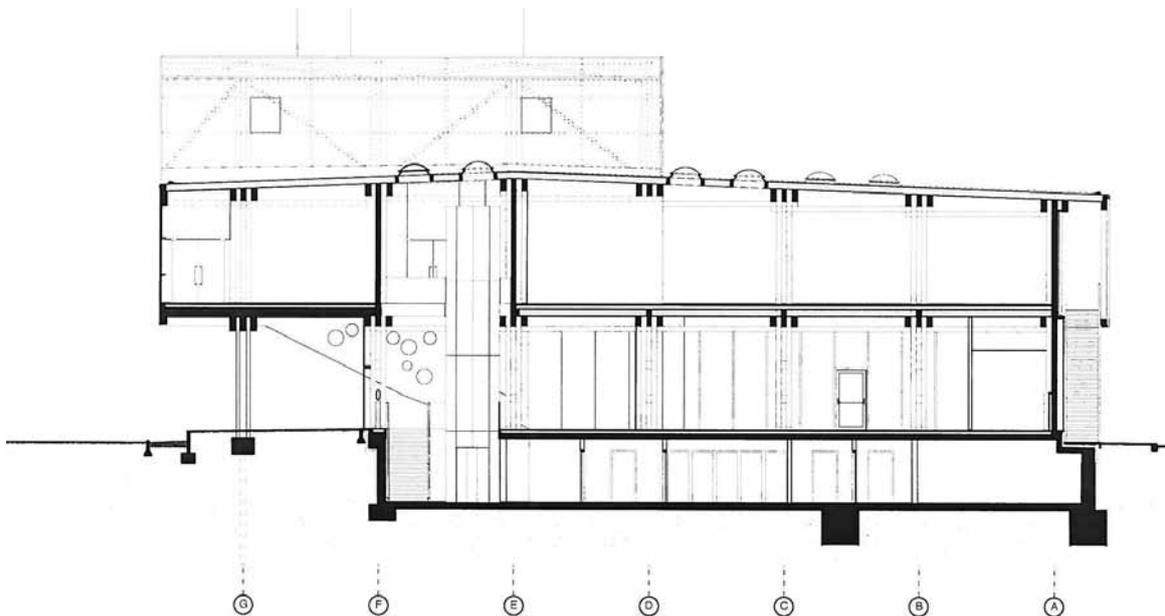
Schnitt Ausstellungshalle - Ausführung
